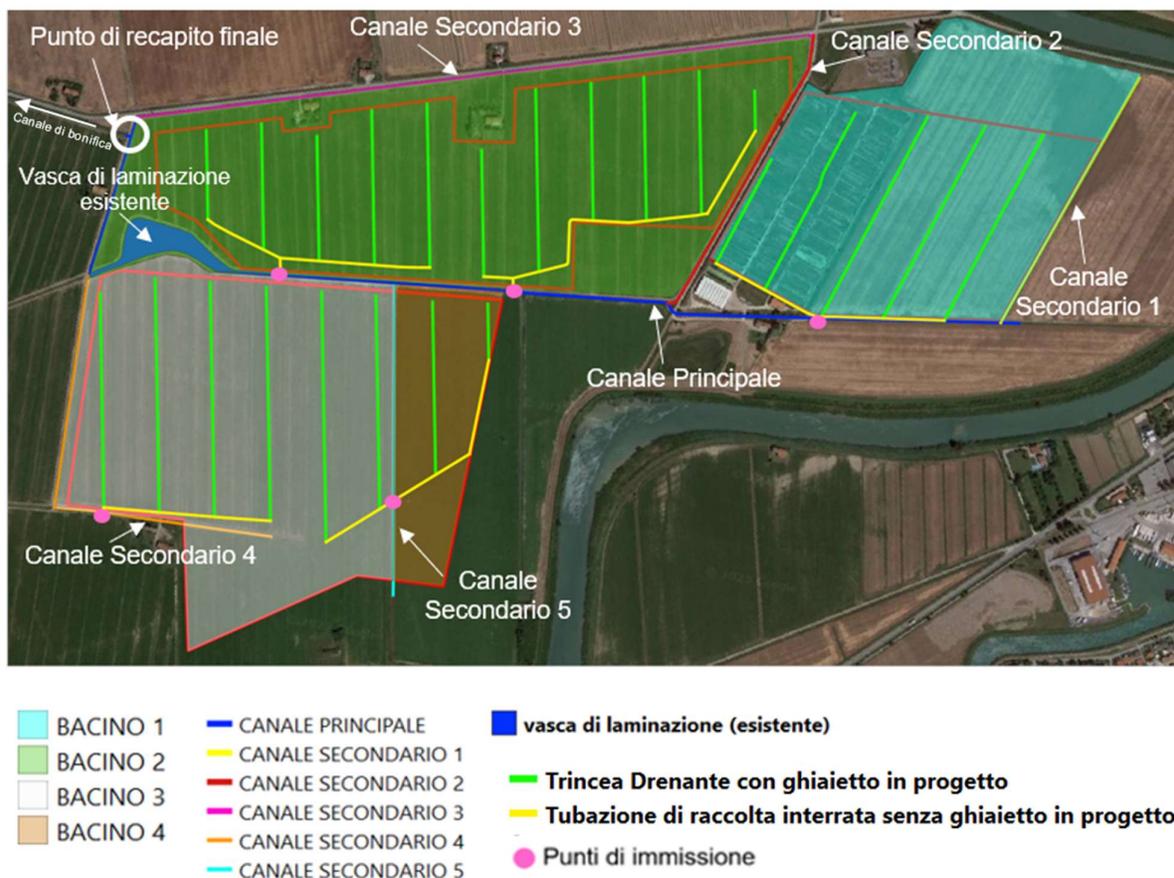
Schematizzazione del sistema di drenaggio dell'area di impianto in progetto
